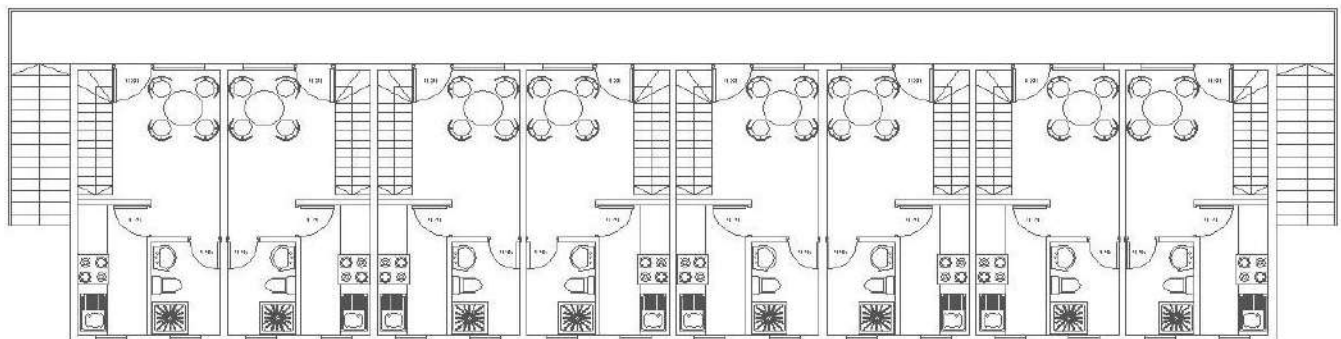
Planta Arquitectónica, Villa Las Viñitas, Elaboración propia.
